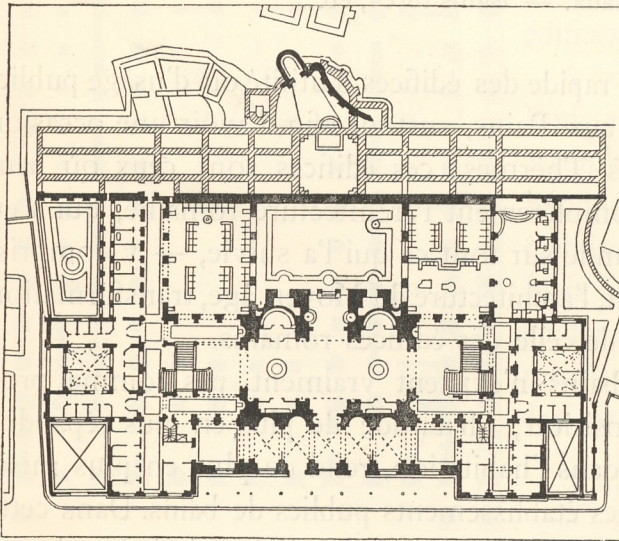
Établissement thermal du Mont-Dore. Plan du rez-de-chaussée.
